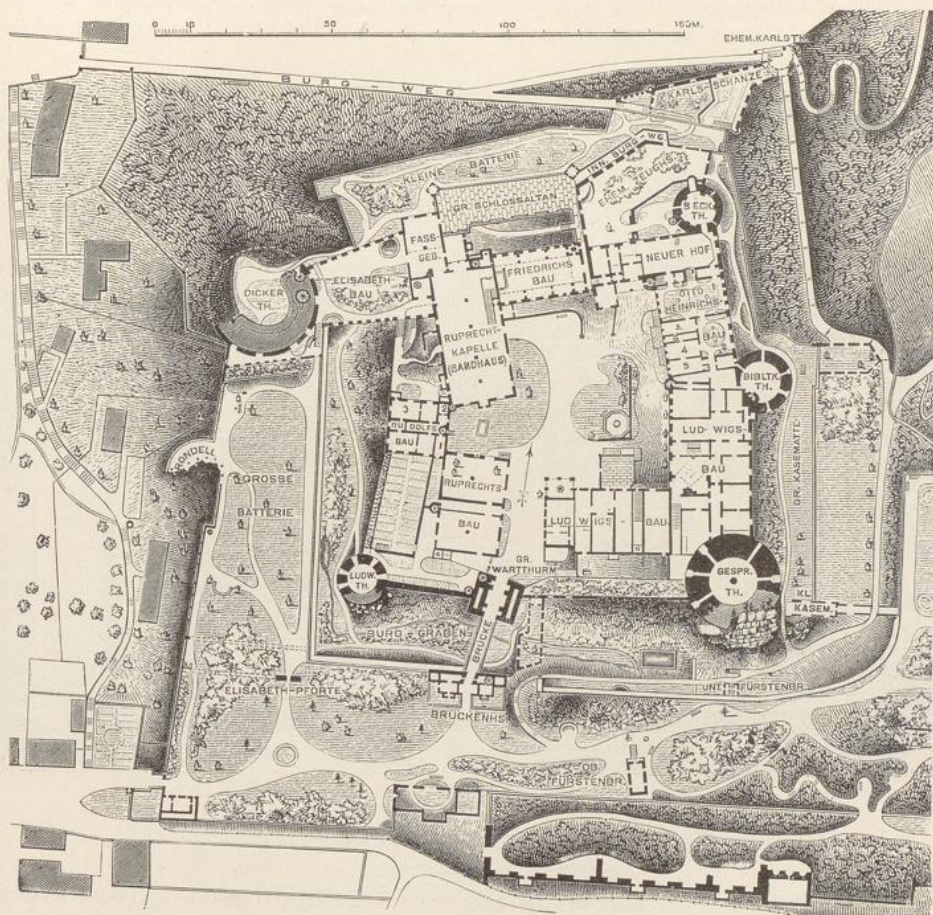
Das Schloß zu Heidelberg. Lageplan.
